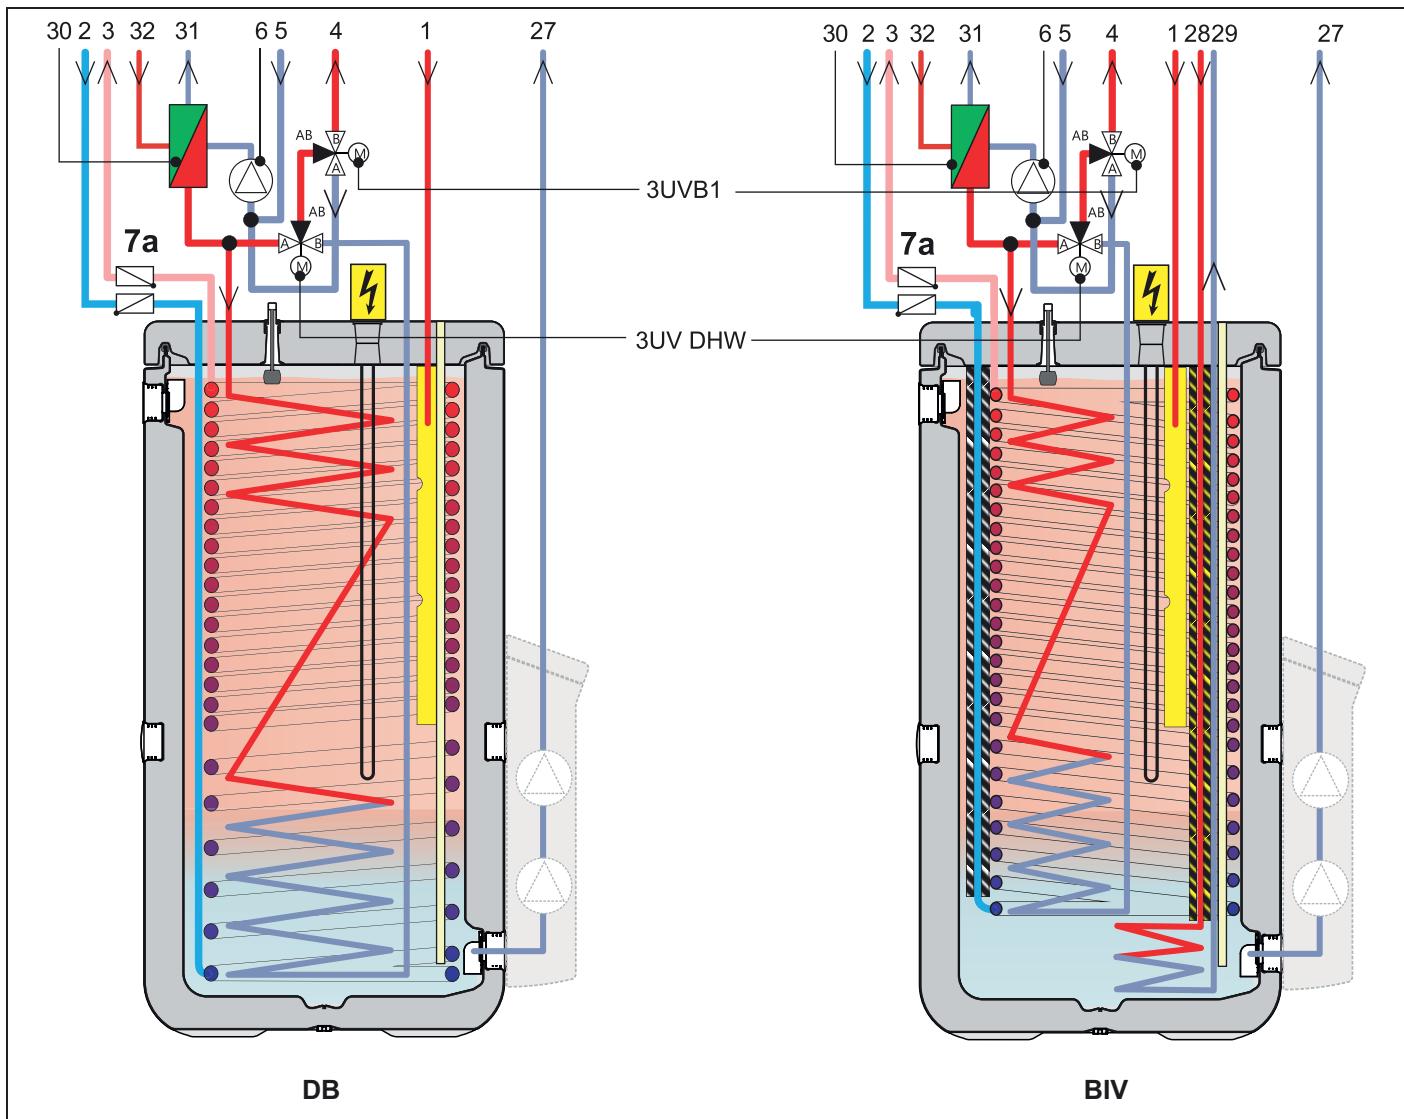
Hydraulischer Aufbau - Innengeräte - HPSU compact 5xx
